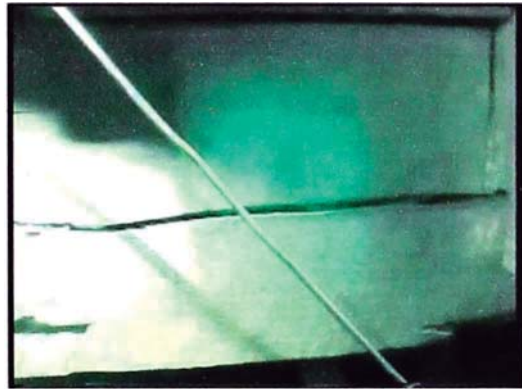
Deterioro en la cobertura exterior de bóvedas nervadas de madera.
